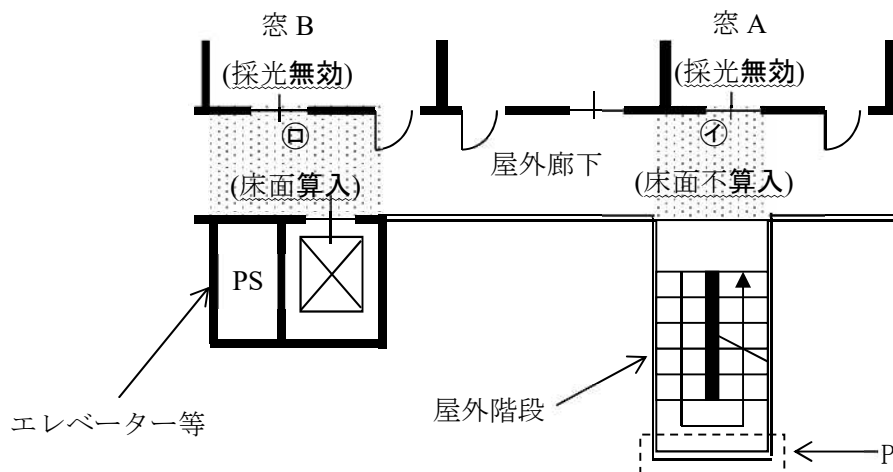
屋外廊下に面して設ける屋外階段・エレベーター等の平面図
